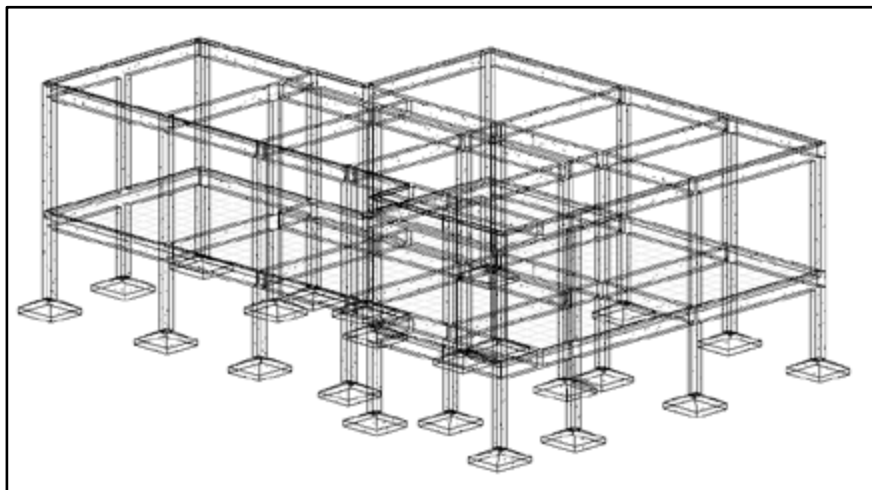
3D estrutura de arame da planta estrutural da edificação.
